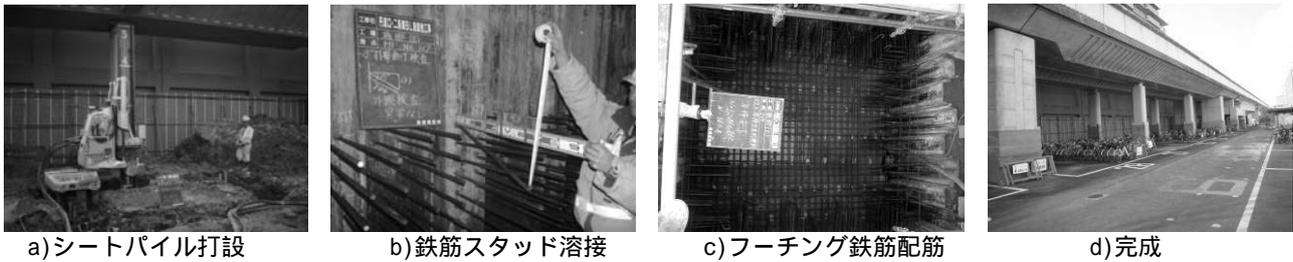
施工および完成写真（JR 嵯峨野線輸送改善工事）
